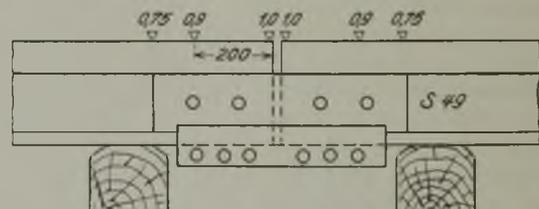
Schwebender Stoß auf Stoßbrücke.
